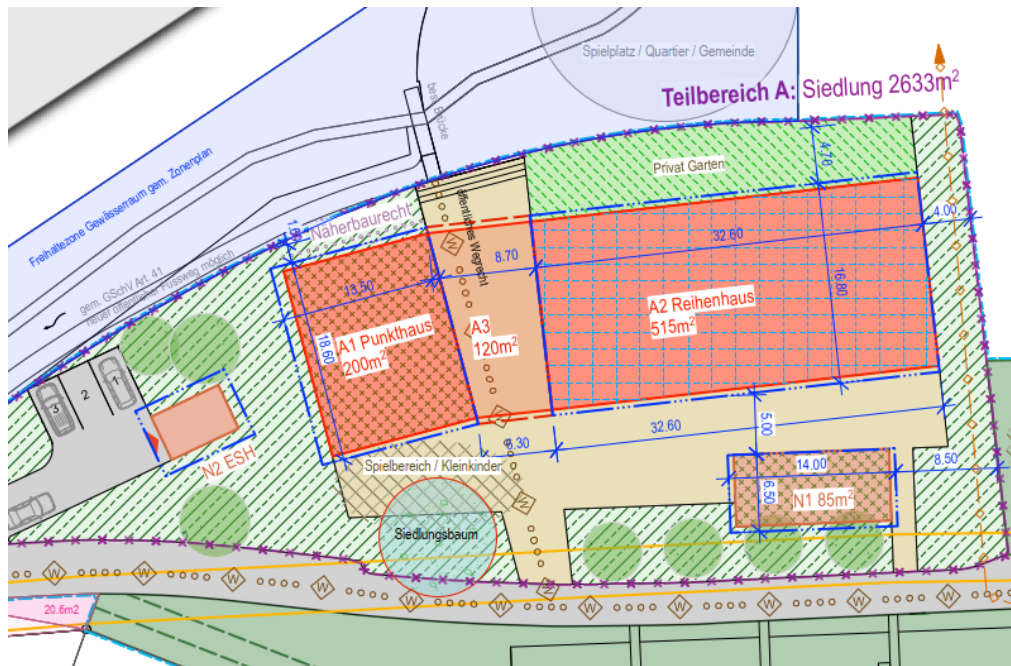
Ausschnitt Gestaltungsplan erste Gebäudegruppe nach Anpassungen aufgrund Dialogabende und Gespräche mit Nachbarschaft (Stand 31.01.2025)
